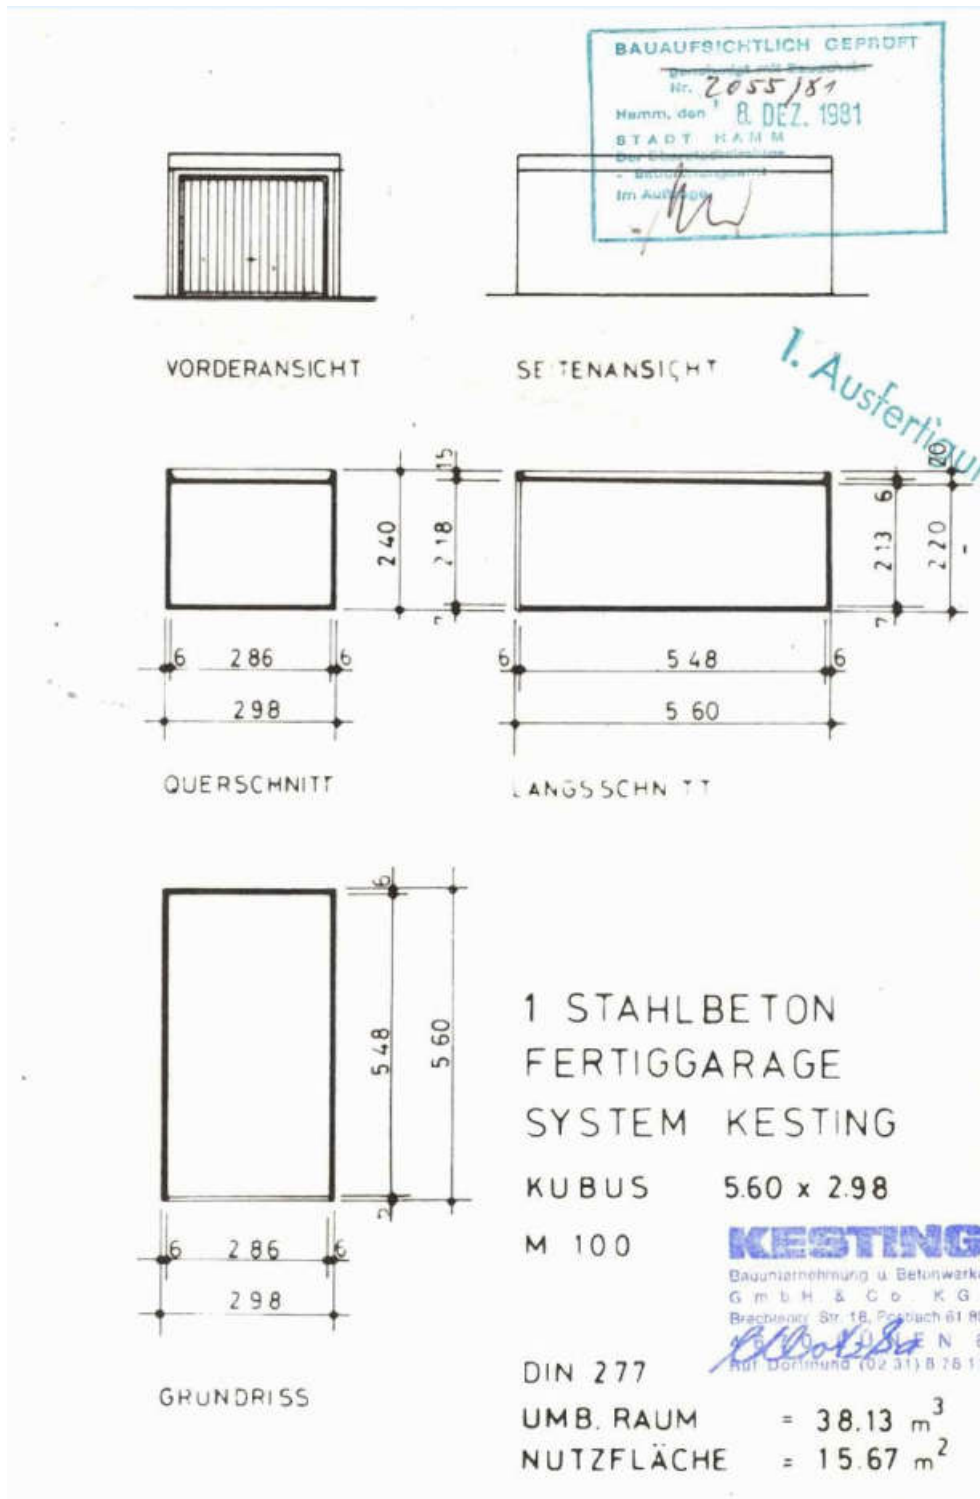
Zeichnung Ansicht/Grundriss Garage
